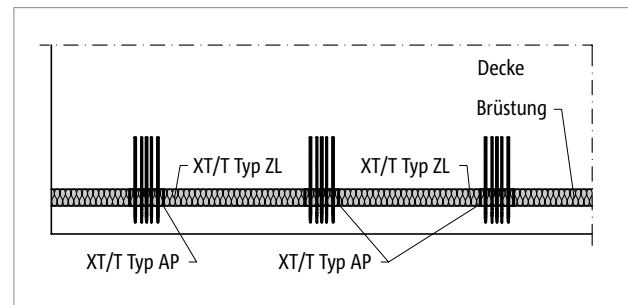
Schöck Isokorb® XT/T Typ AP horizontale Anordnung: Ansicht Brüstung vorgesetzt
